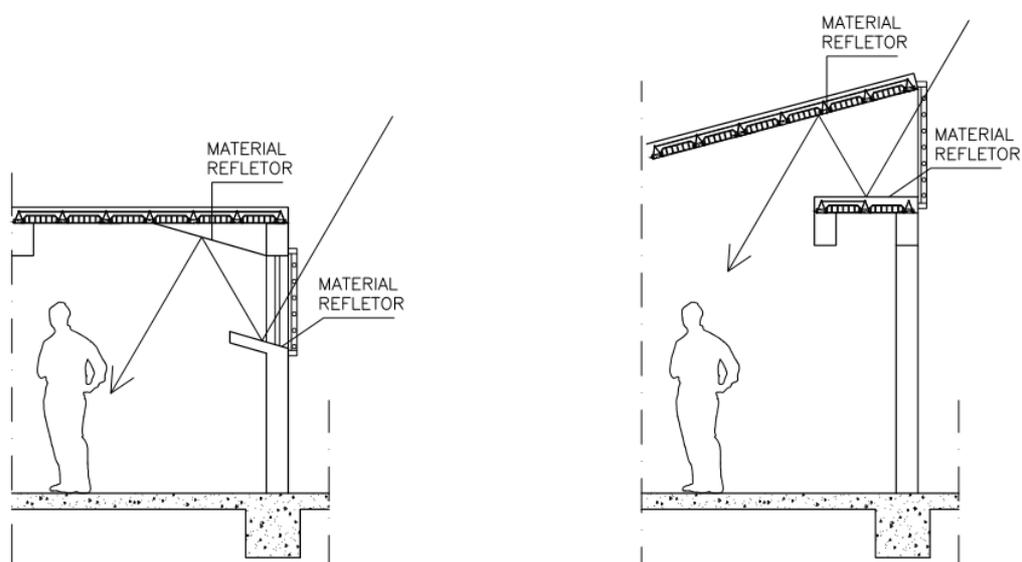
Perfil longitudinal da Iluminação zenital Lanternin.
